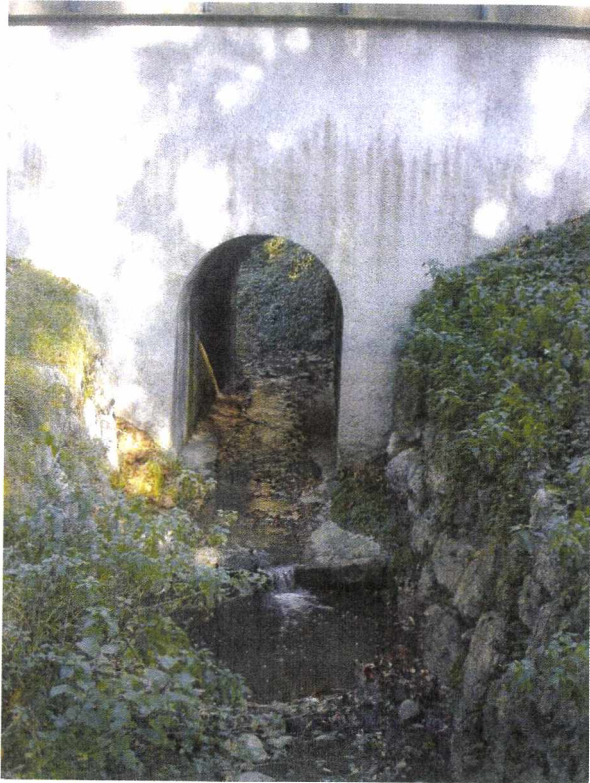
Les ouvrages de franchissement sur le ruisseau sont tous en bon état.
